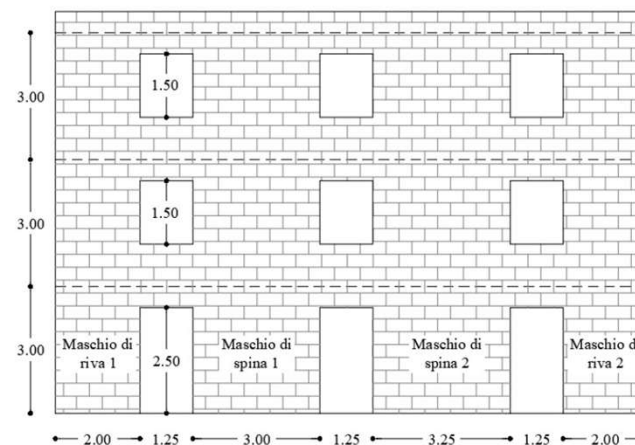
Geometria della parete oggetto di studio (dimensioni in m).
